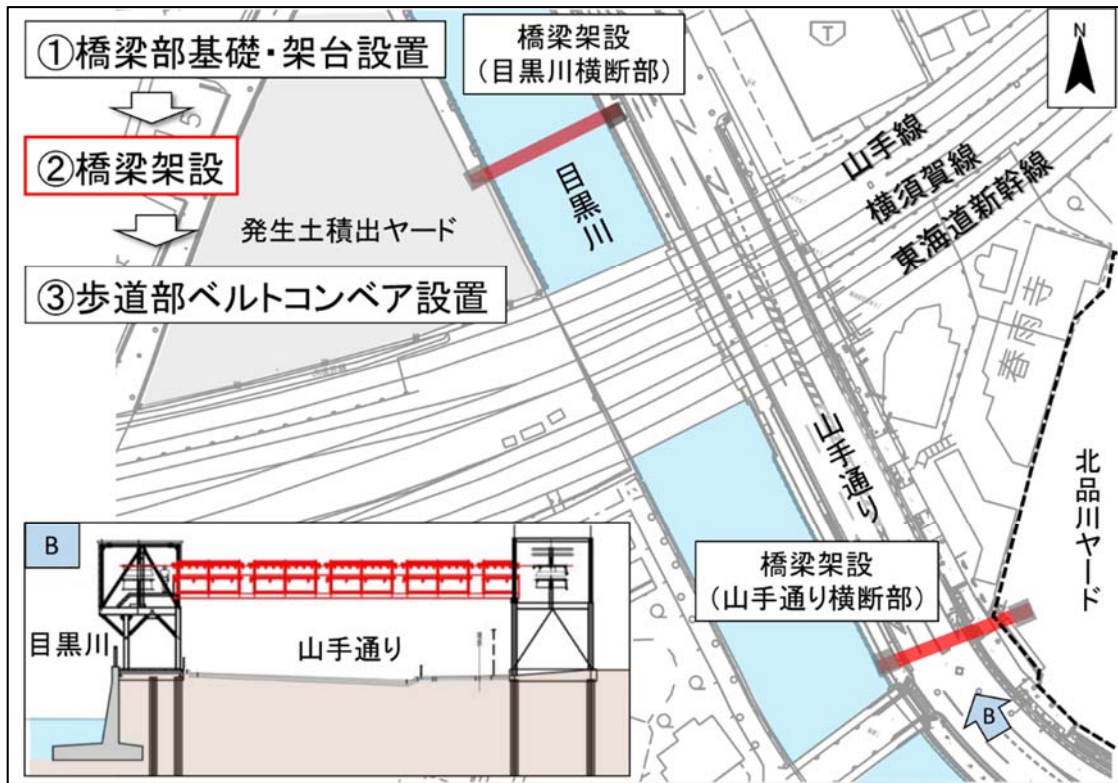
ベルトコンベア設置の施工手順 (②橋梁架設)
